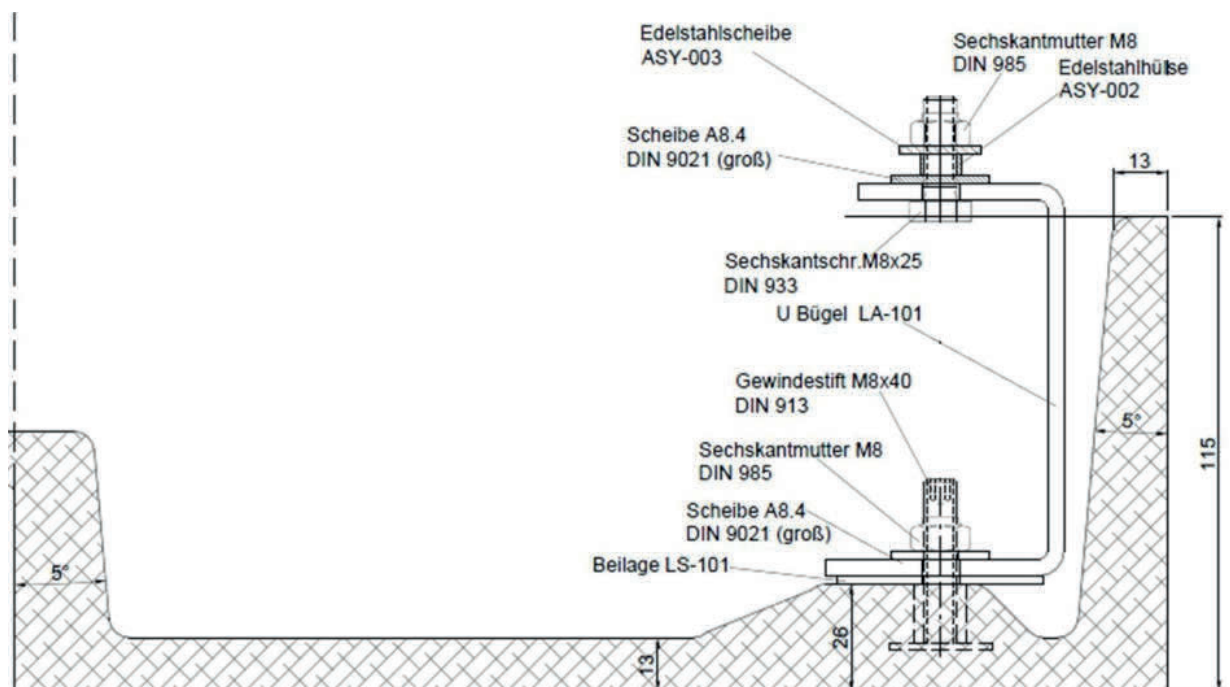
Schematischer Aufbau der Befestigungspunkte im Fassadenelement
